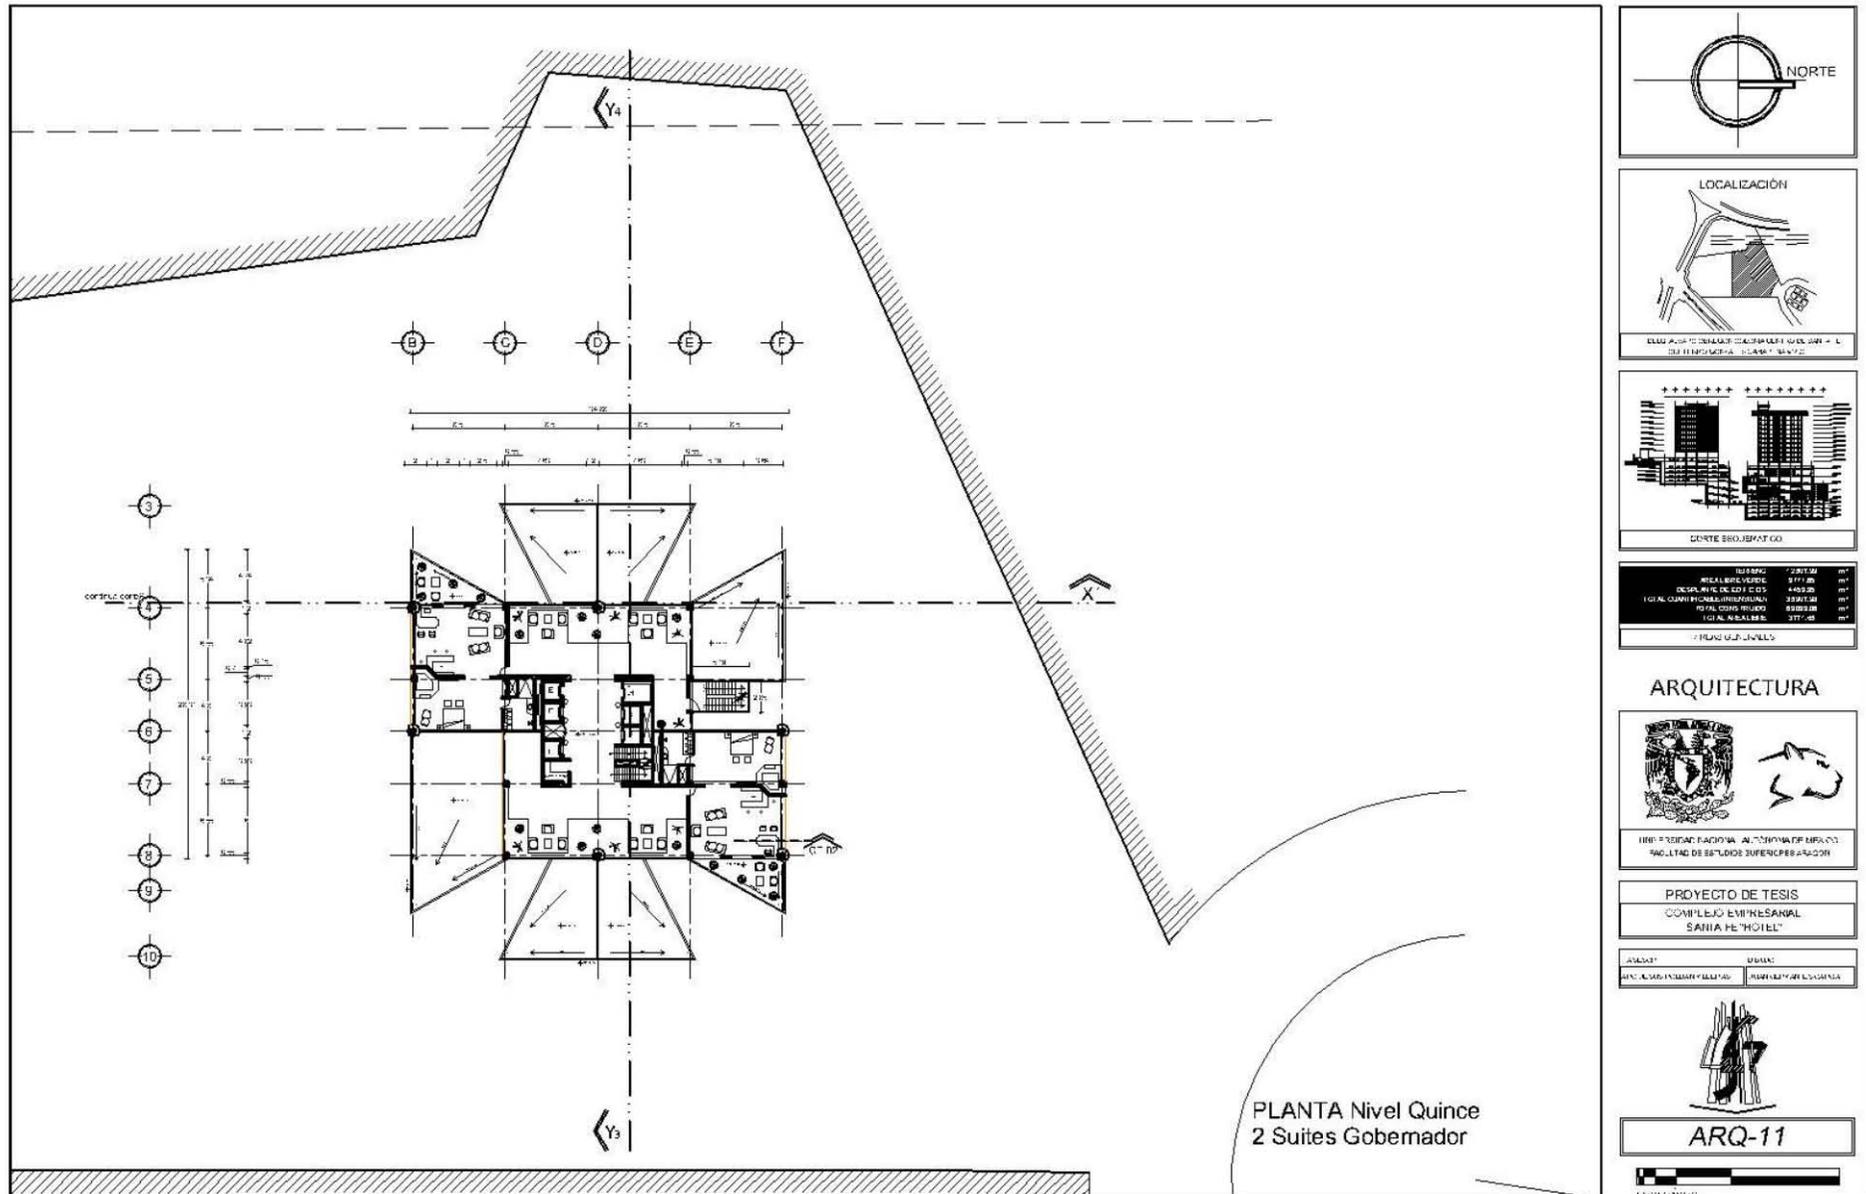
Plano ARQ-11; Planta Suite Gobernador Nivel Quince Hotel. Edición propia.
